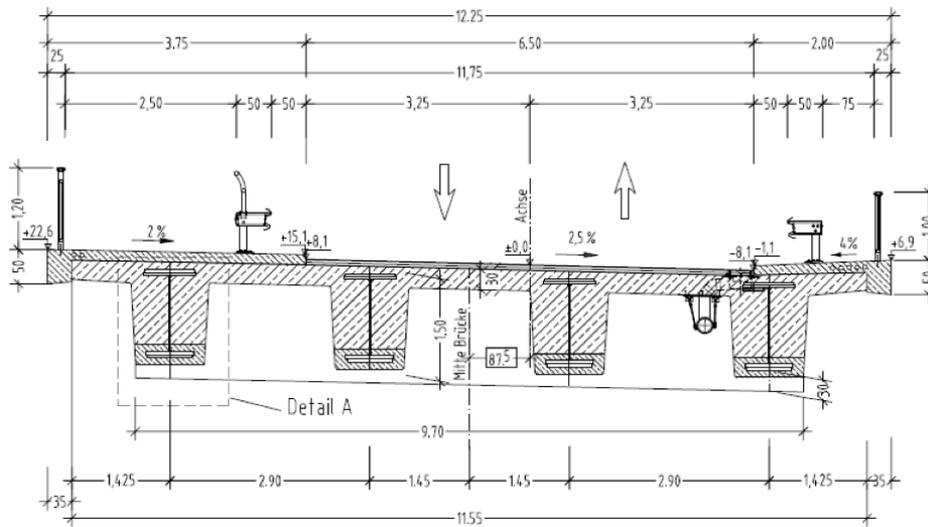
Brückenquerschnitt mit Fertigteilträgern
